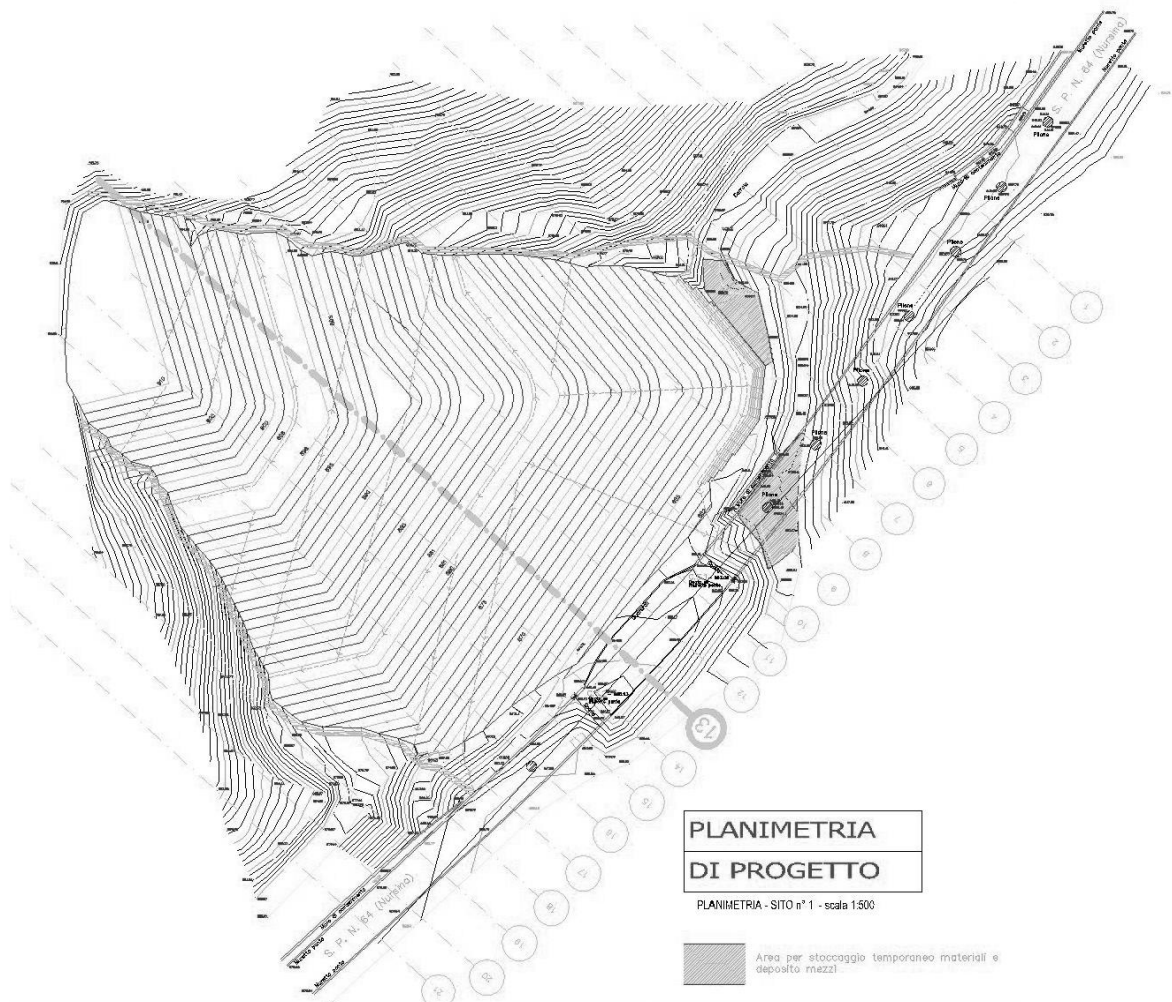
Stralcio planimetrico e indicazione della sezione di verifica sito 1 del progetto esecutivo
